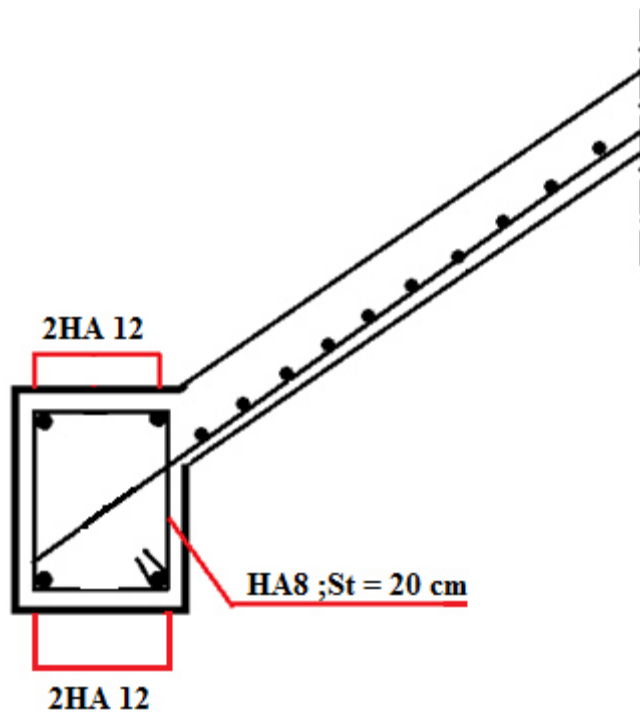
Schéma du ferrailage de la poutre de ceinture.
